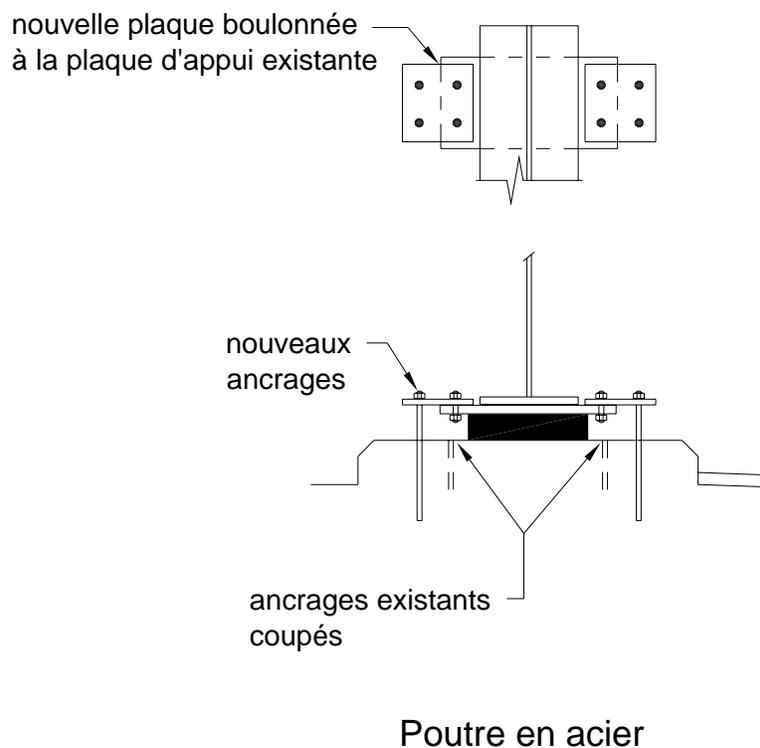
Modification de la fixité d'un appareil d'appui
